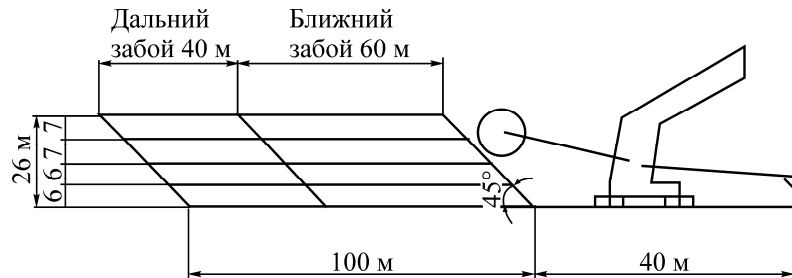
Поперечный разрез двойного забоя для экскаватора SchRs 4600 × 50. Схема деления заходки
